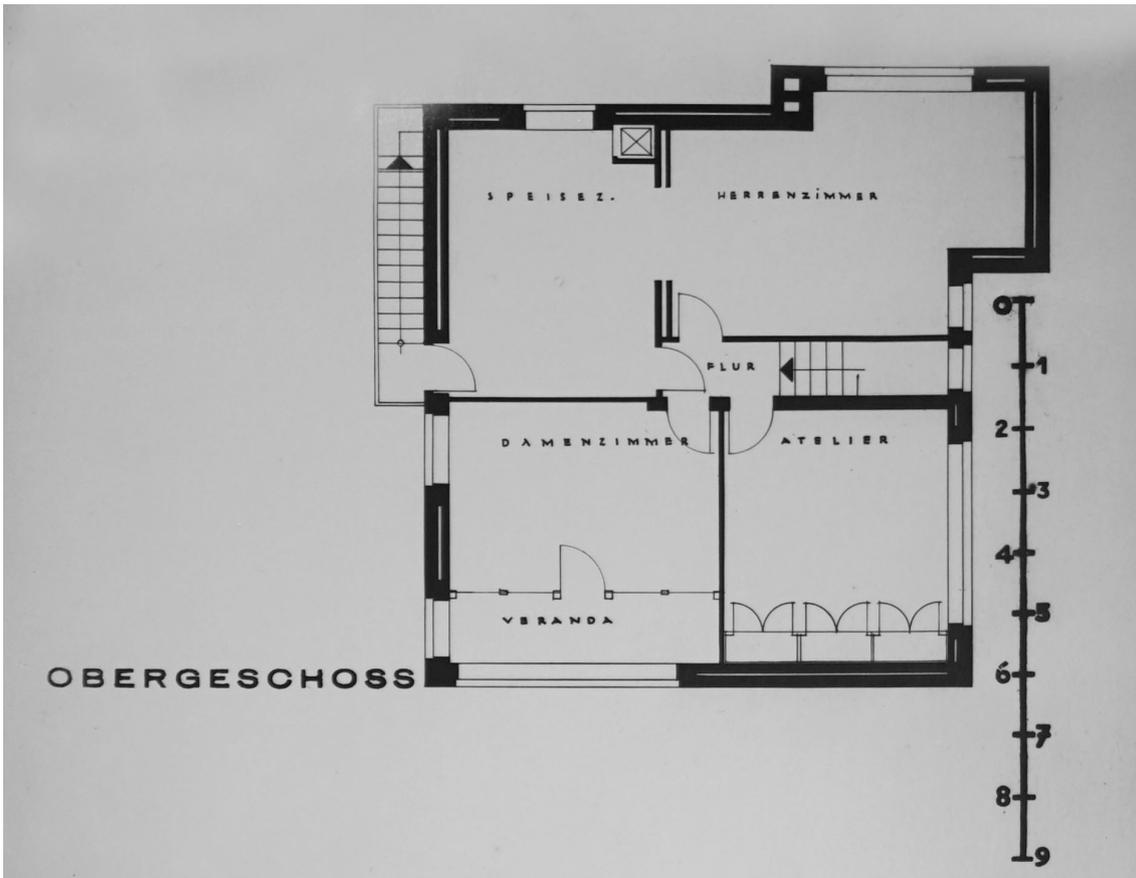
Grundriss Obergeschoss, Publikationsplan, ohne Datum
